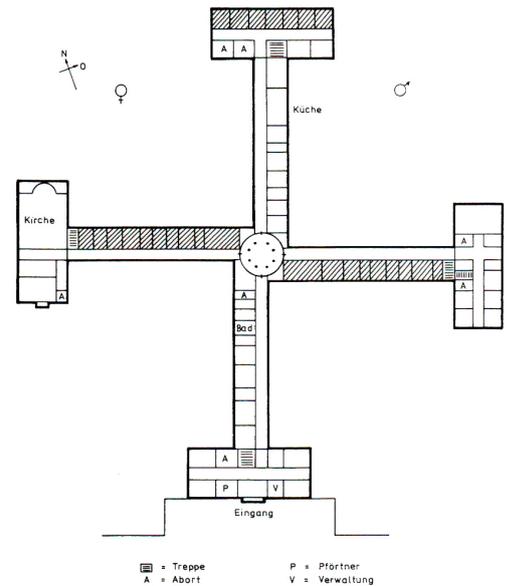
Grundriss Kreisirrenanstalt Erlangen
